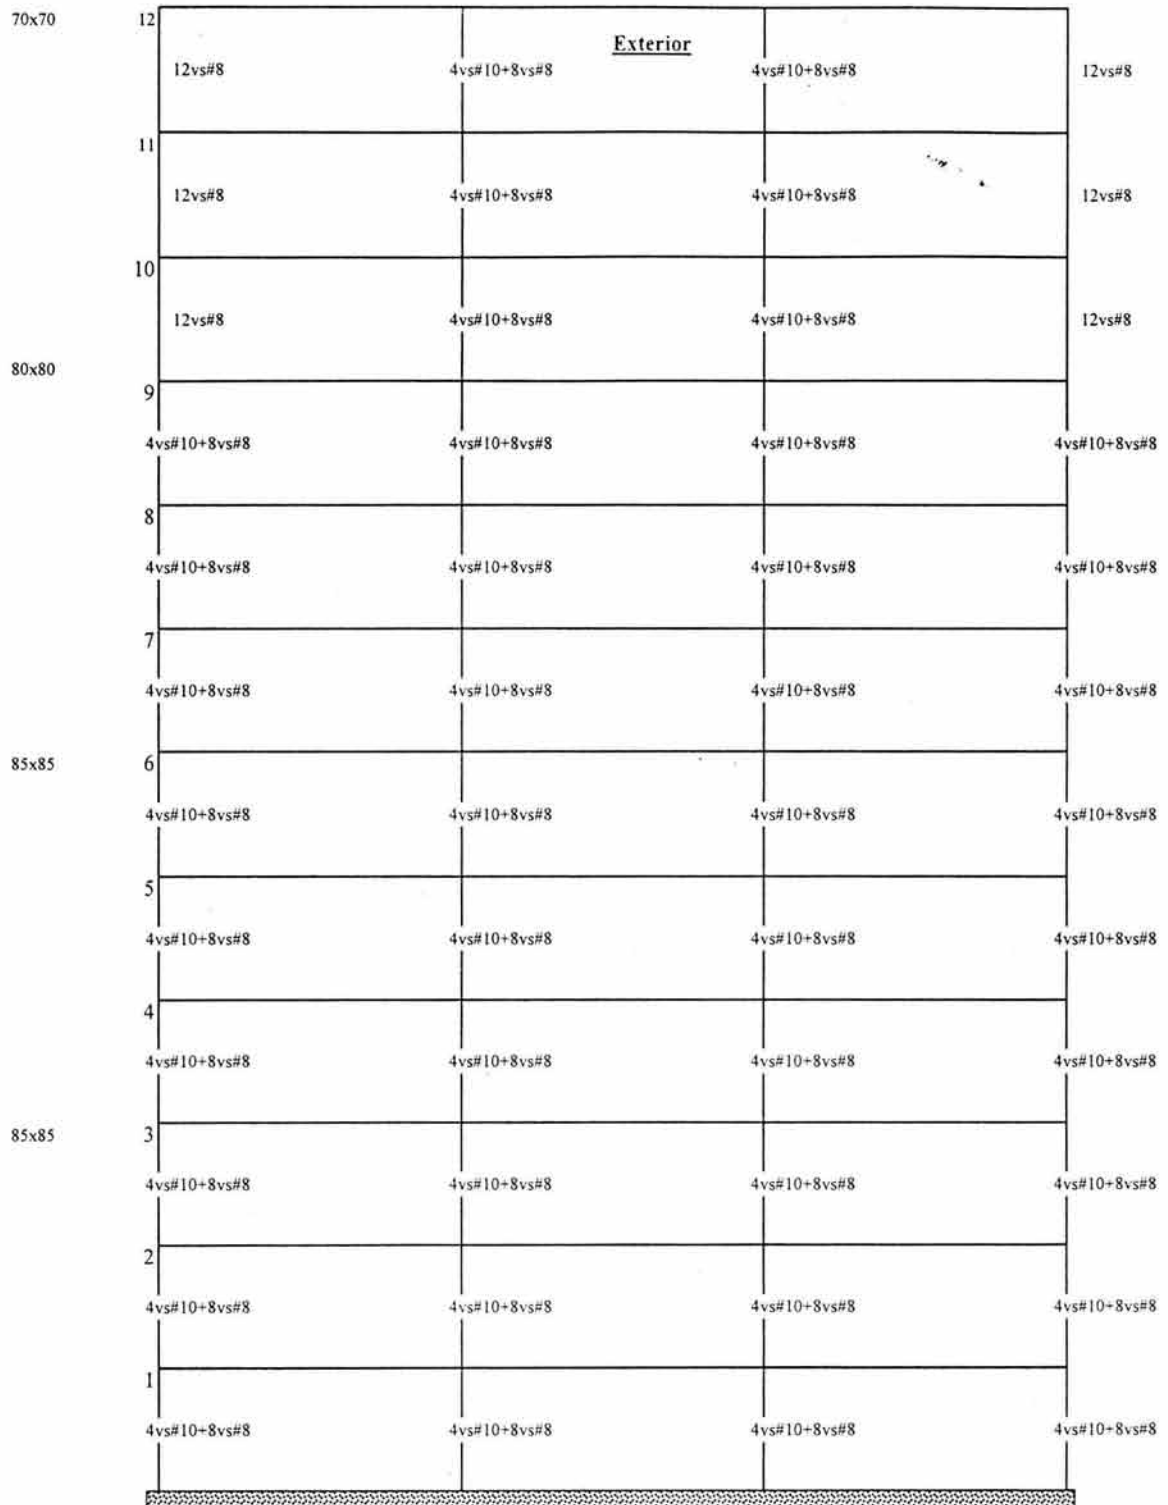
Armado de las columnas para el edificio de 12 niveles marco exterior.
